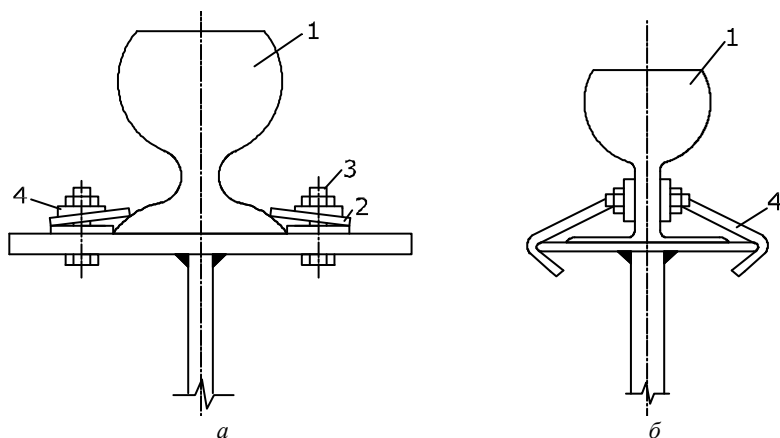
Схемы крепления подкрановых рельсов к стальным балкам:
